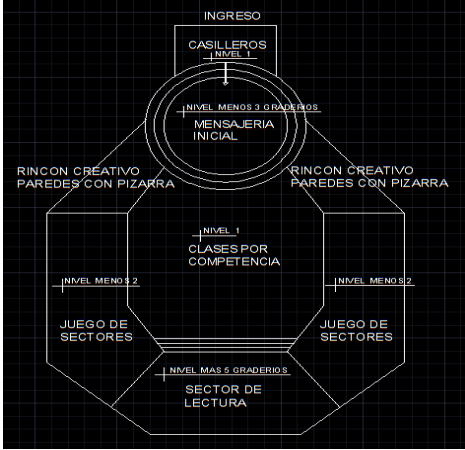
Primer boceto arquitectónico de planteamiento de aula, elaboración propia, 2018.
